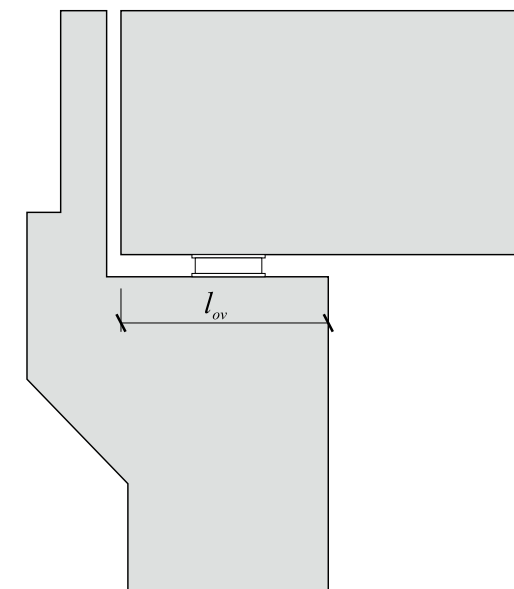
Definición de la longitud de entrega, l_{ov} , para un tablero apoyado en un estribo
